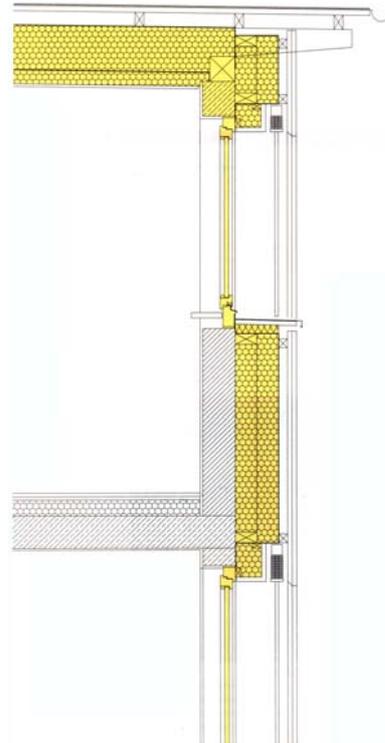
Wärmebrückenminimierung im Bereich Dachvorsprung
